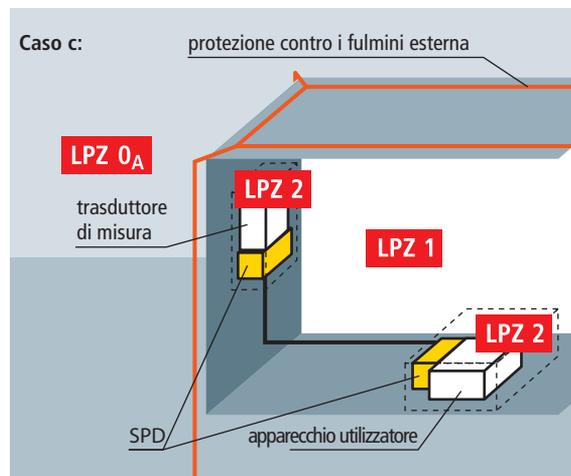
Edificio con sistema di protezione contro i fulmini esterna e linee installate all'interno dell'edificio secondo il concetto di zona protezione contro i fulmini
